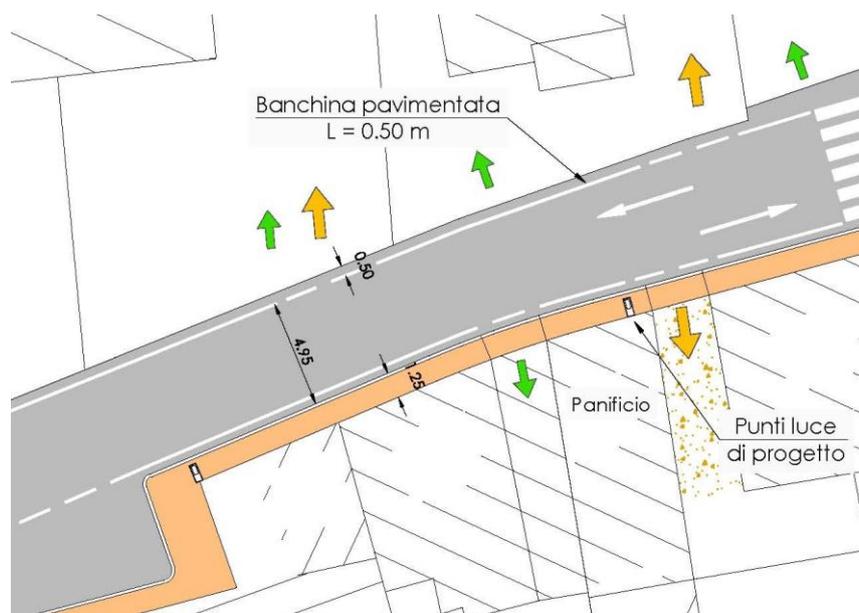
Planimetria di progetto – dettaglio – strada Castelletto
